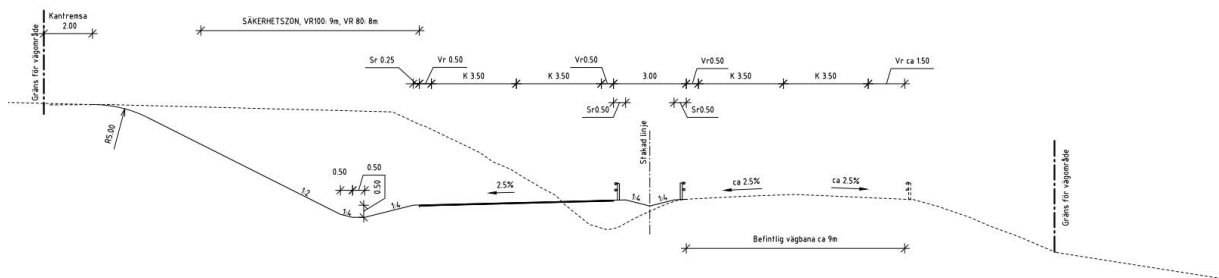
Typsektion ytväg 2+2 körfält med mitträcke (Tpl Flottsbro - Glömstatunneln, Glömstatunneln - tpl Kästa, Tpl Solgård - Flemingsbergstunneln).
